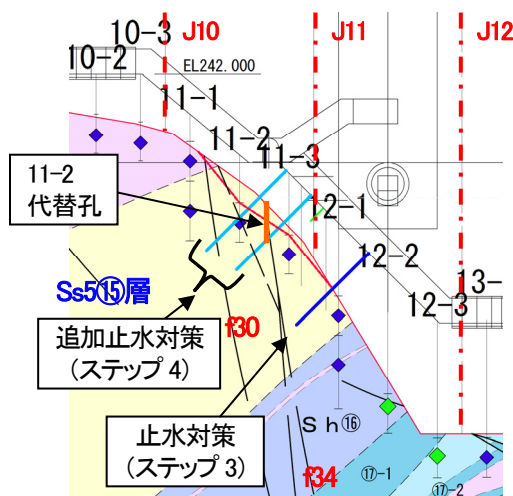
J-11周辺基礎岩盤の遮水グラウチング配置図(正面図)
